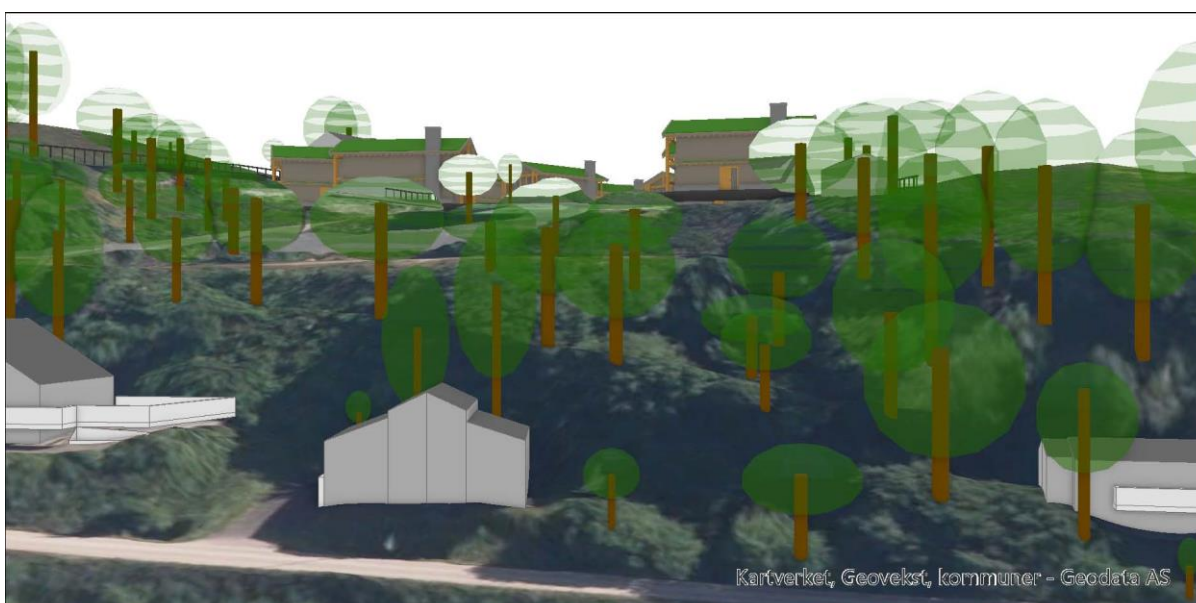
Innsyn mot planområdet fra fylkesveien øst for planområdet vist med vegetasjon.
